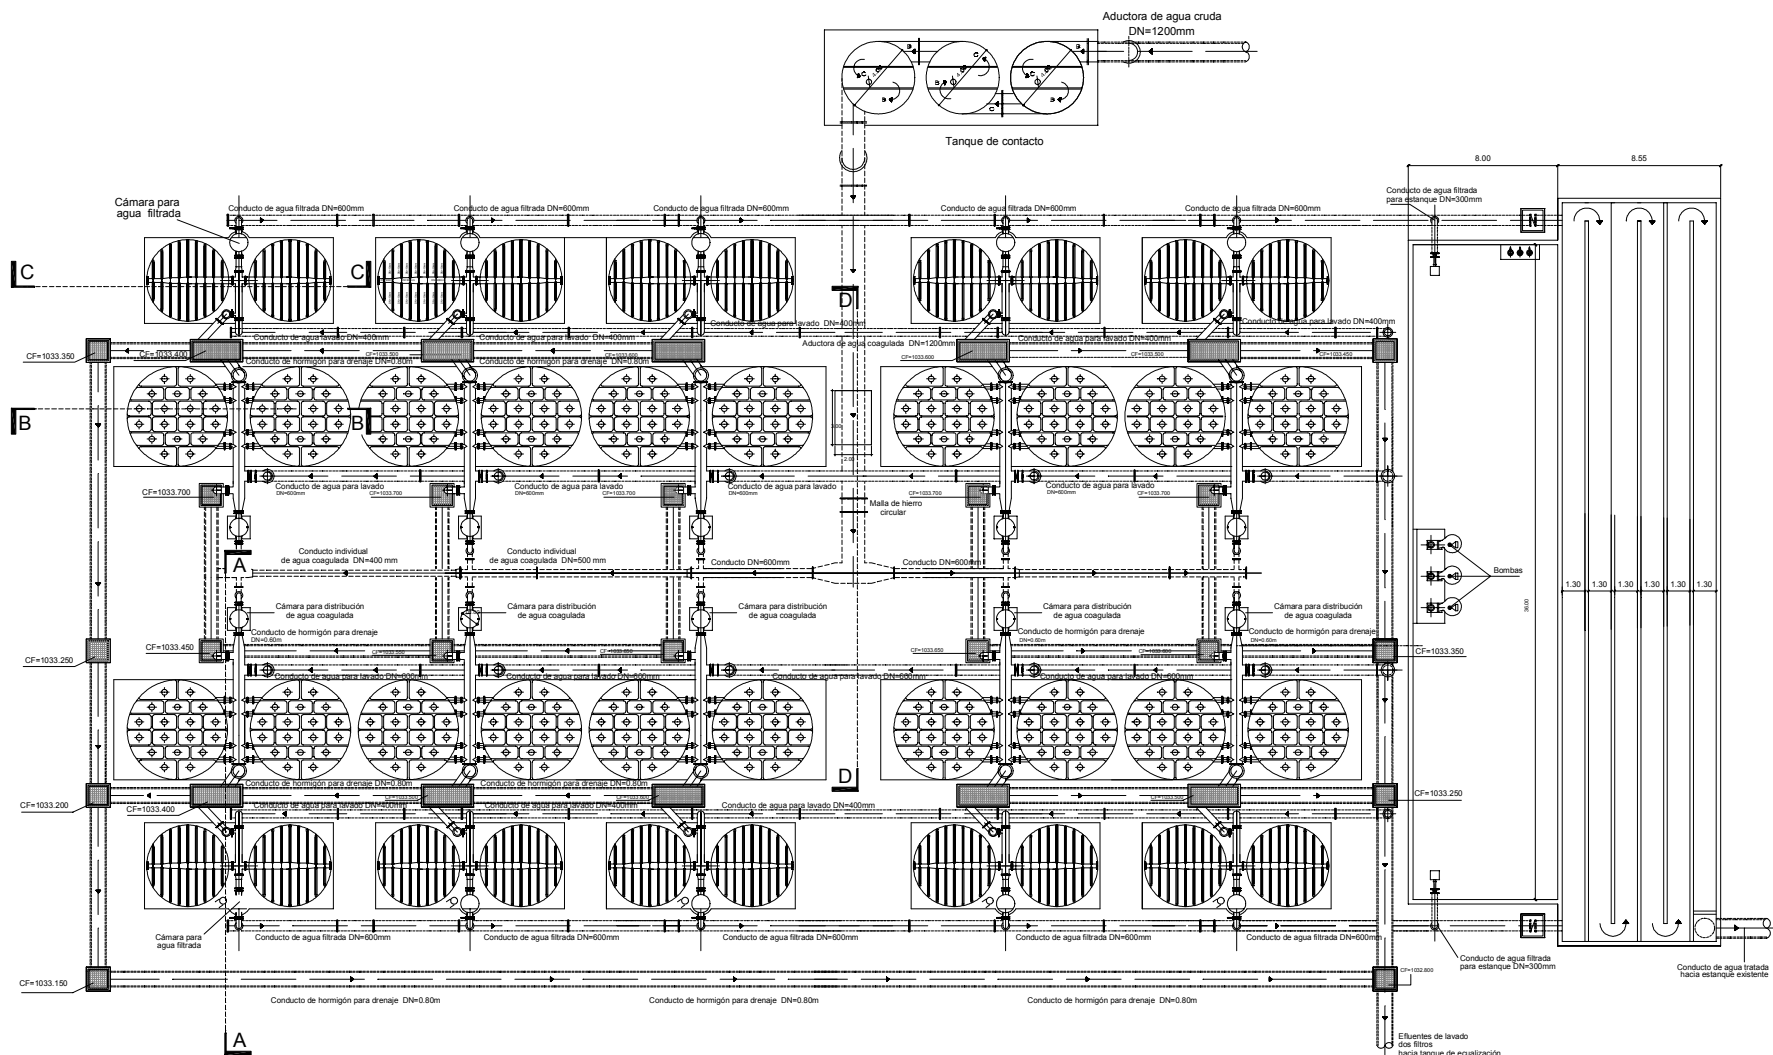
Planta de potabilización con filtros de flujo ascendente–descendente - Planta Inferior
